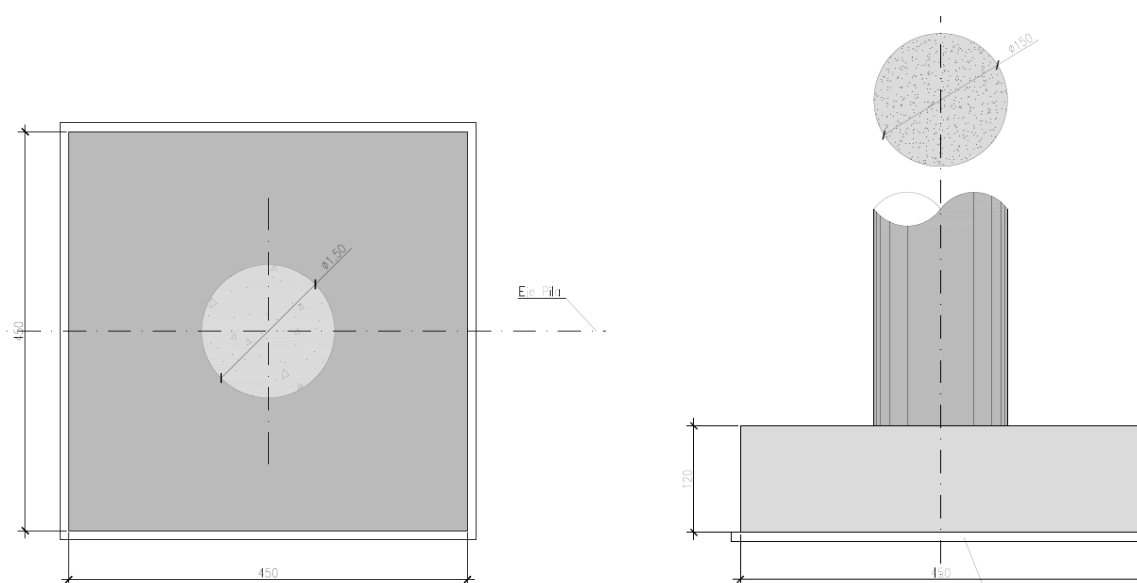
Planta e alçado tipos das sapatas e pilares.
